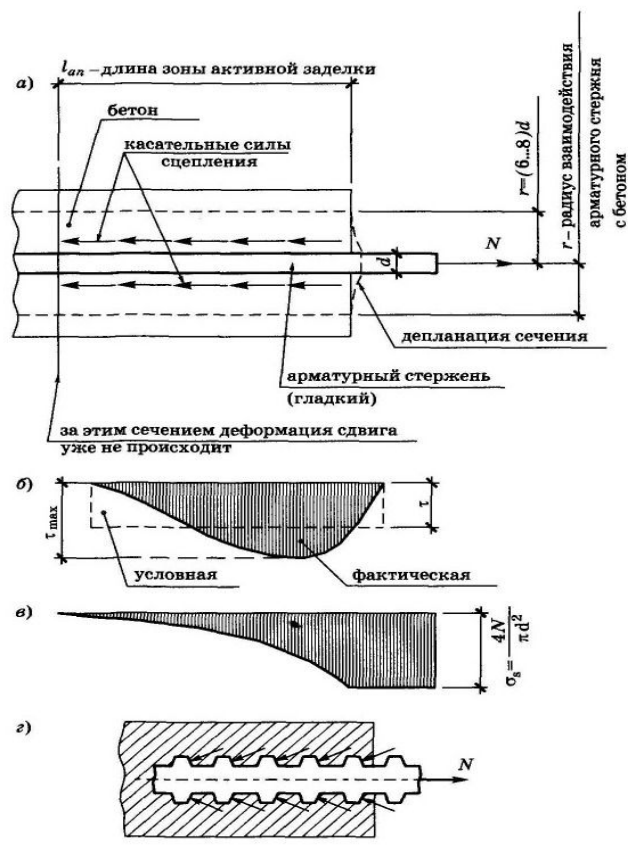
Сцепление арматуры с бетоном: а — арматурный стержень в бетоне; б — эпюра касательных напряжений сцепления; в - эпюра нормальных напряжений; г — при арматуре периодического профиля
